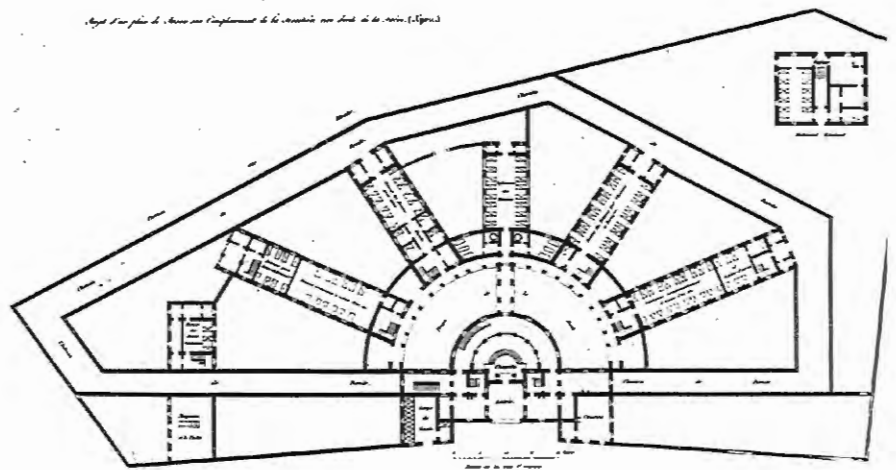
Planta para desenvolvimento de uma prisão em Lyon – França. Início do século XIX.
